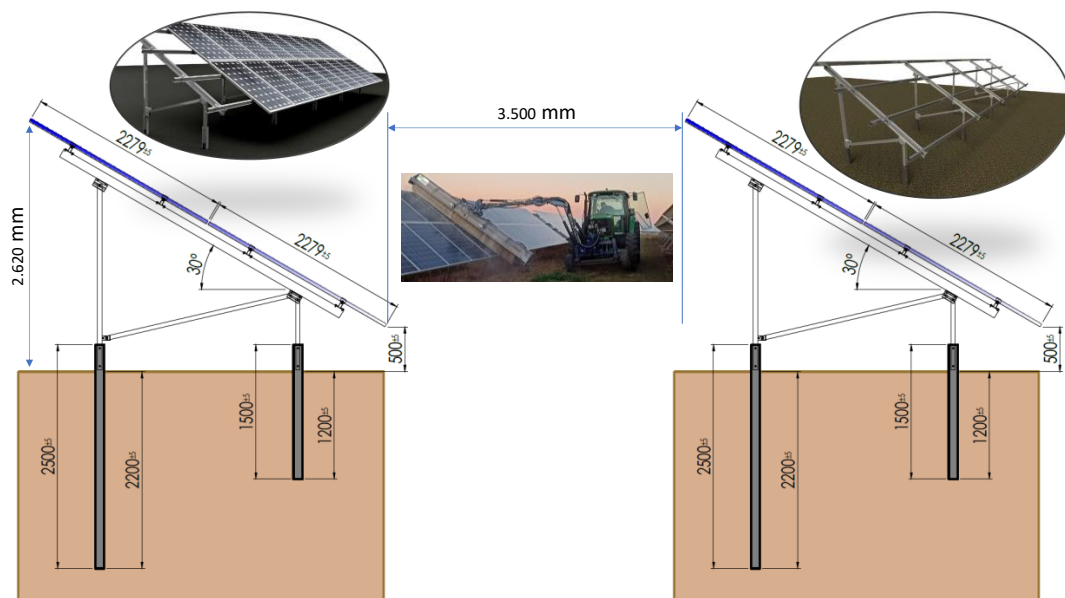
Disposición de las hileras de estructuras de soporte de los paneles en la planta fotovoltaico
